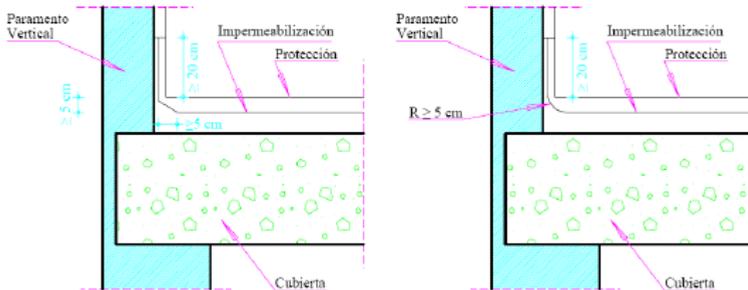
Encuentro de la cubierta con paramento vertical. Fuente CTE
